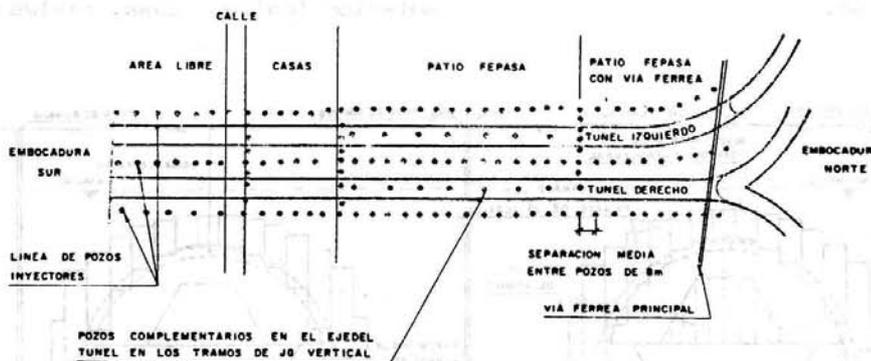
SISTEMA DE REBAJE DE LA NAPA FREATICA
